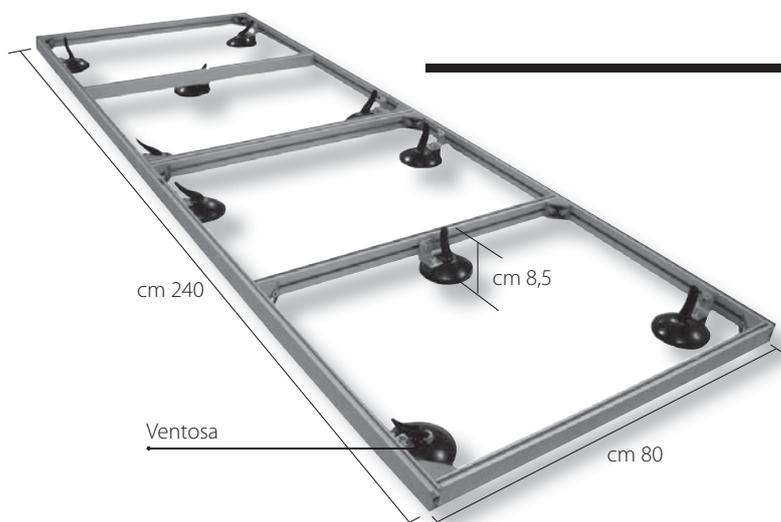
/5 - Le lastre di KERLITE nelle sue varie tipologie nel formato 300x100 cm possono essere movimentate da due persone con l'ausilio di un apposito telaio. Fissare il telaio alla lastra quando è ancora all'interno del pallet. Quindi sollevare il telaio e la lastra per eliminare l'effetto ventosa.
